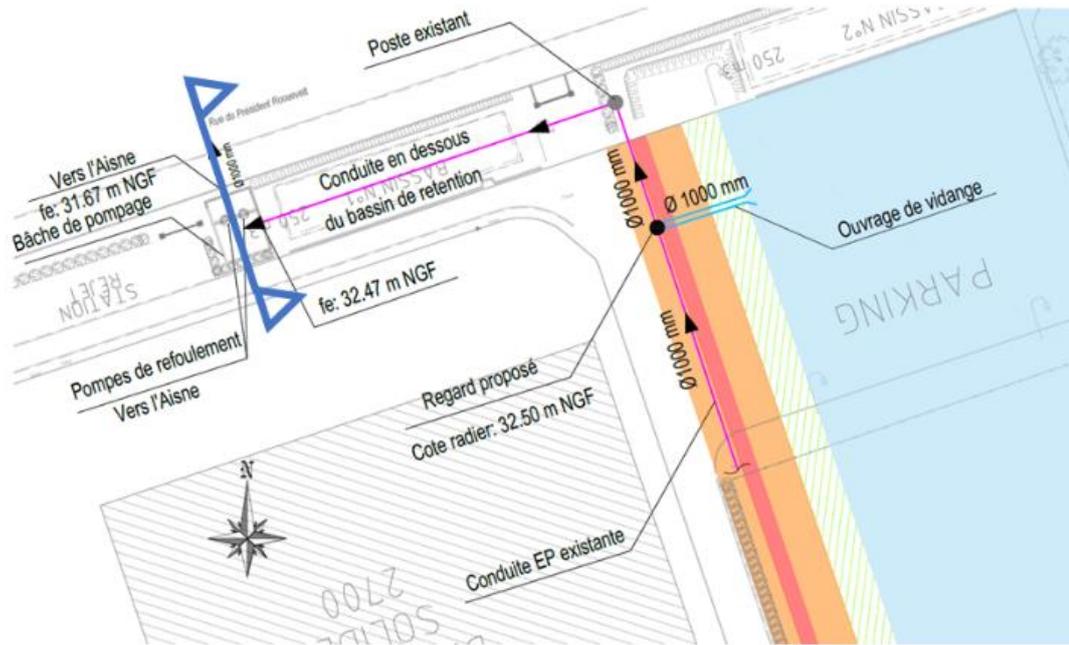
Vue en plan de la conduite DN 1000 existante et de l'ouvrage de vidange des eaux du bassin de compensation
